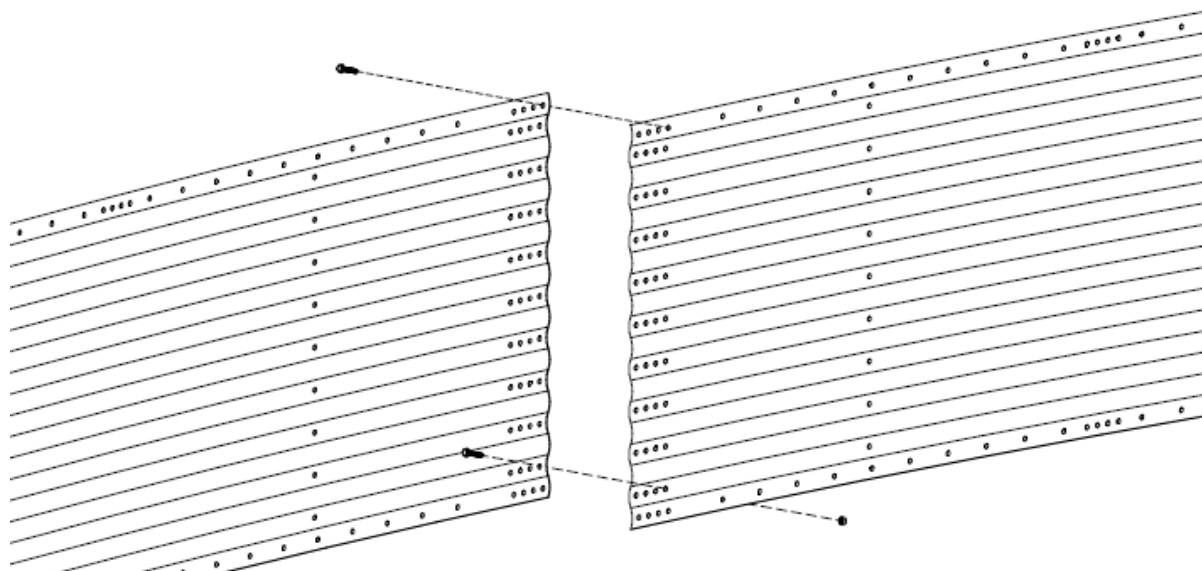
Modelo de ligação parafusada entre chapas metálicas.
